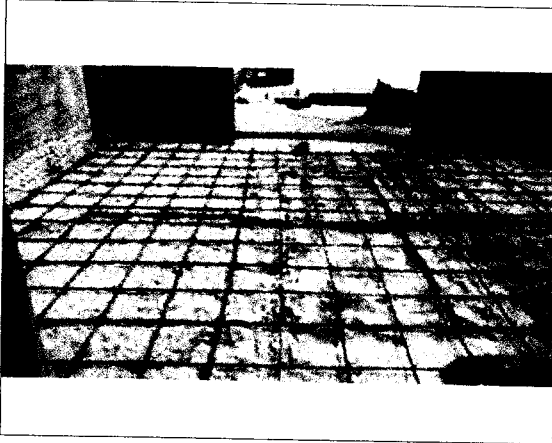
HABILITADO DE ACERO PARA LOSA ARMADA
